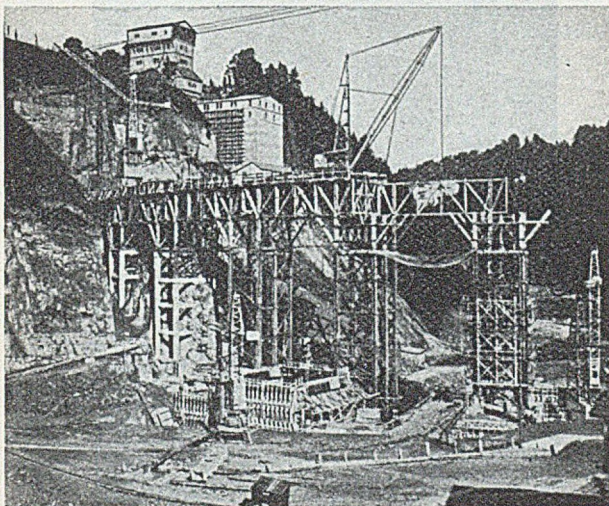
Rossens-Staumauer (Schweiz). Betonieranlage.
